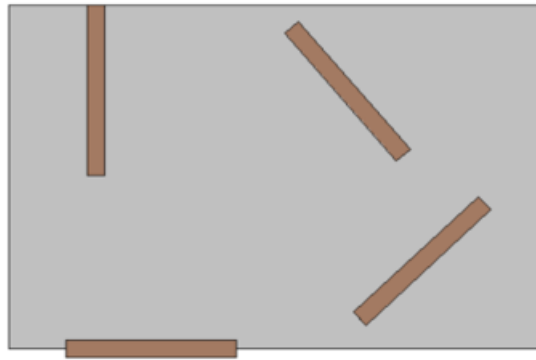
Ketidakberaturan Horizontal Tipe 4
